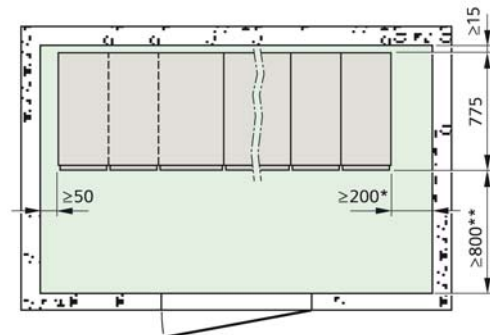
Стандарт: Сброс давления вниз (вид сверху)
